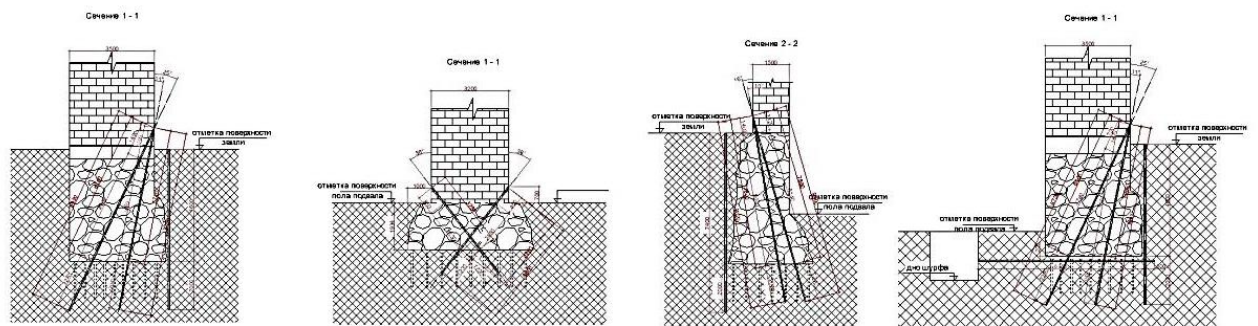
Схема расположения наклонных скважин сквозь тело фундамента для Водяной, Пятницкой и Плотничьей башен
